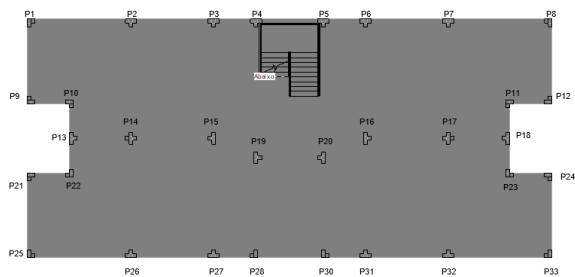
Planta baixa alocação dos pilares. Fonte: Autora 2024.
